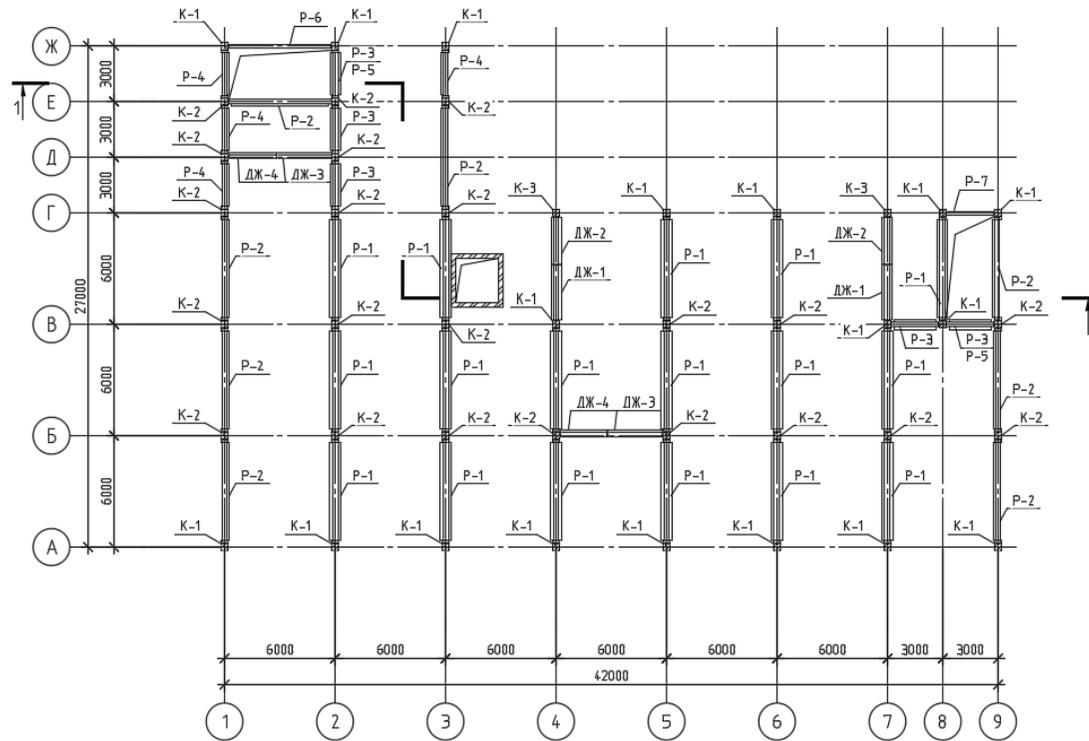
Схема расположения колонн, диафрагм жесткости и ригелей покрытия второго этажа на отметке плюс 8,400
